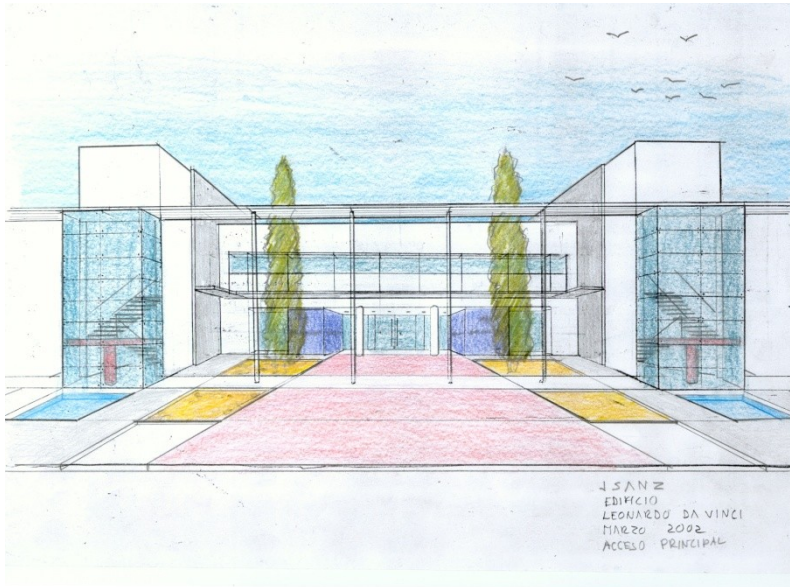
croquis del autor en la fase de la intención y evolución analítica en la proyección arquitectónica de la fachada Sur en Leonardo da Vinci
